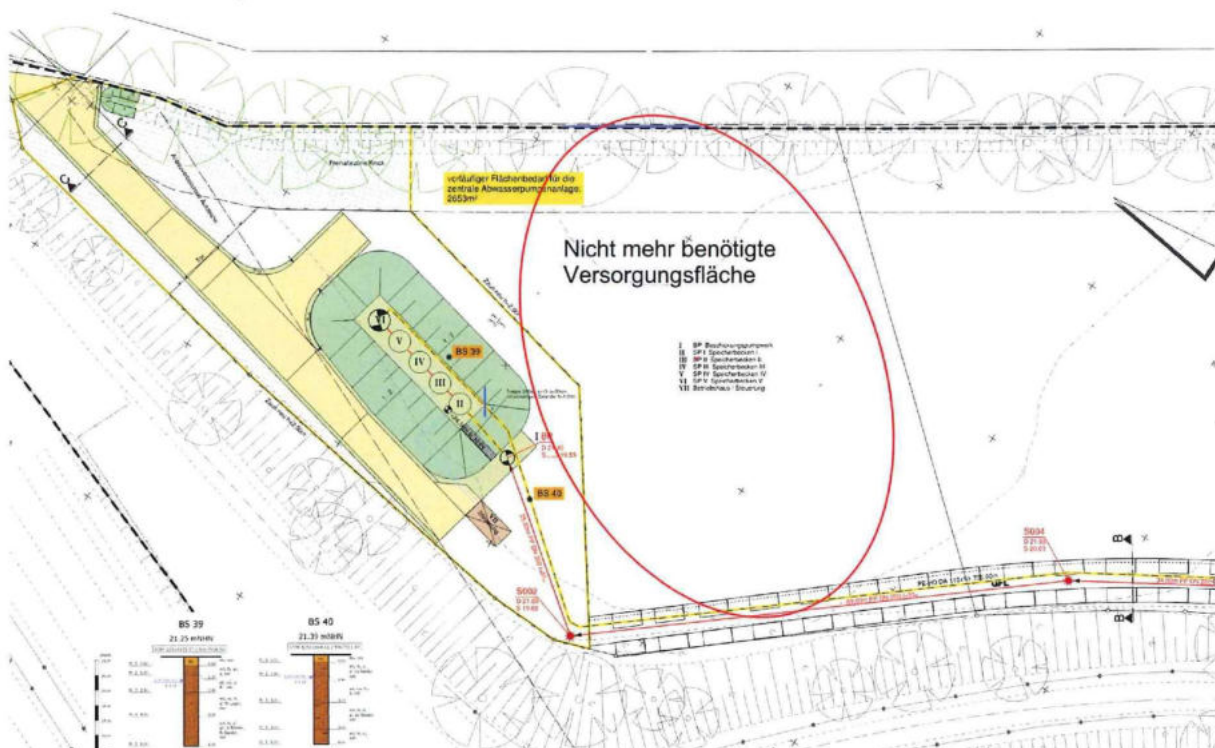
Lageplan Abwasserpumpwerk – W² Ingenieursgemeinschaft
